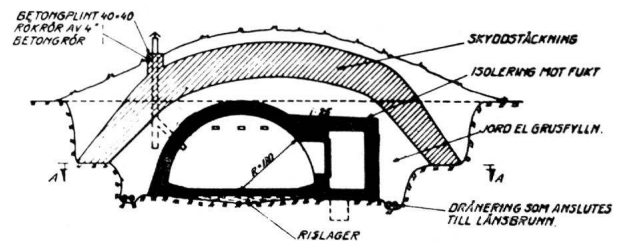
Aufriss B-B. betongplint = Betonsockel 40×40, rökrör = Rauchabzug aus 4"-Betonrohr, skyddstäckning = Schutzbedeckung, isolering mot fukt = Isolierung gegen Feuchtigkeit, jord eller grusfyllning = Erde oder Schotterfüllung, dränering som anslutes till länsbrunn = Entwässerung, an Entleerungsschacht angeschlossen, rislager = Reisiglager.
